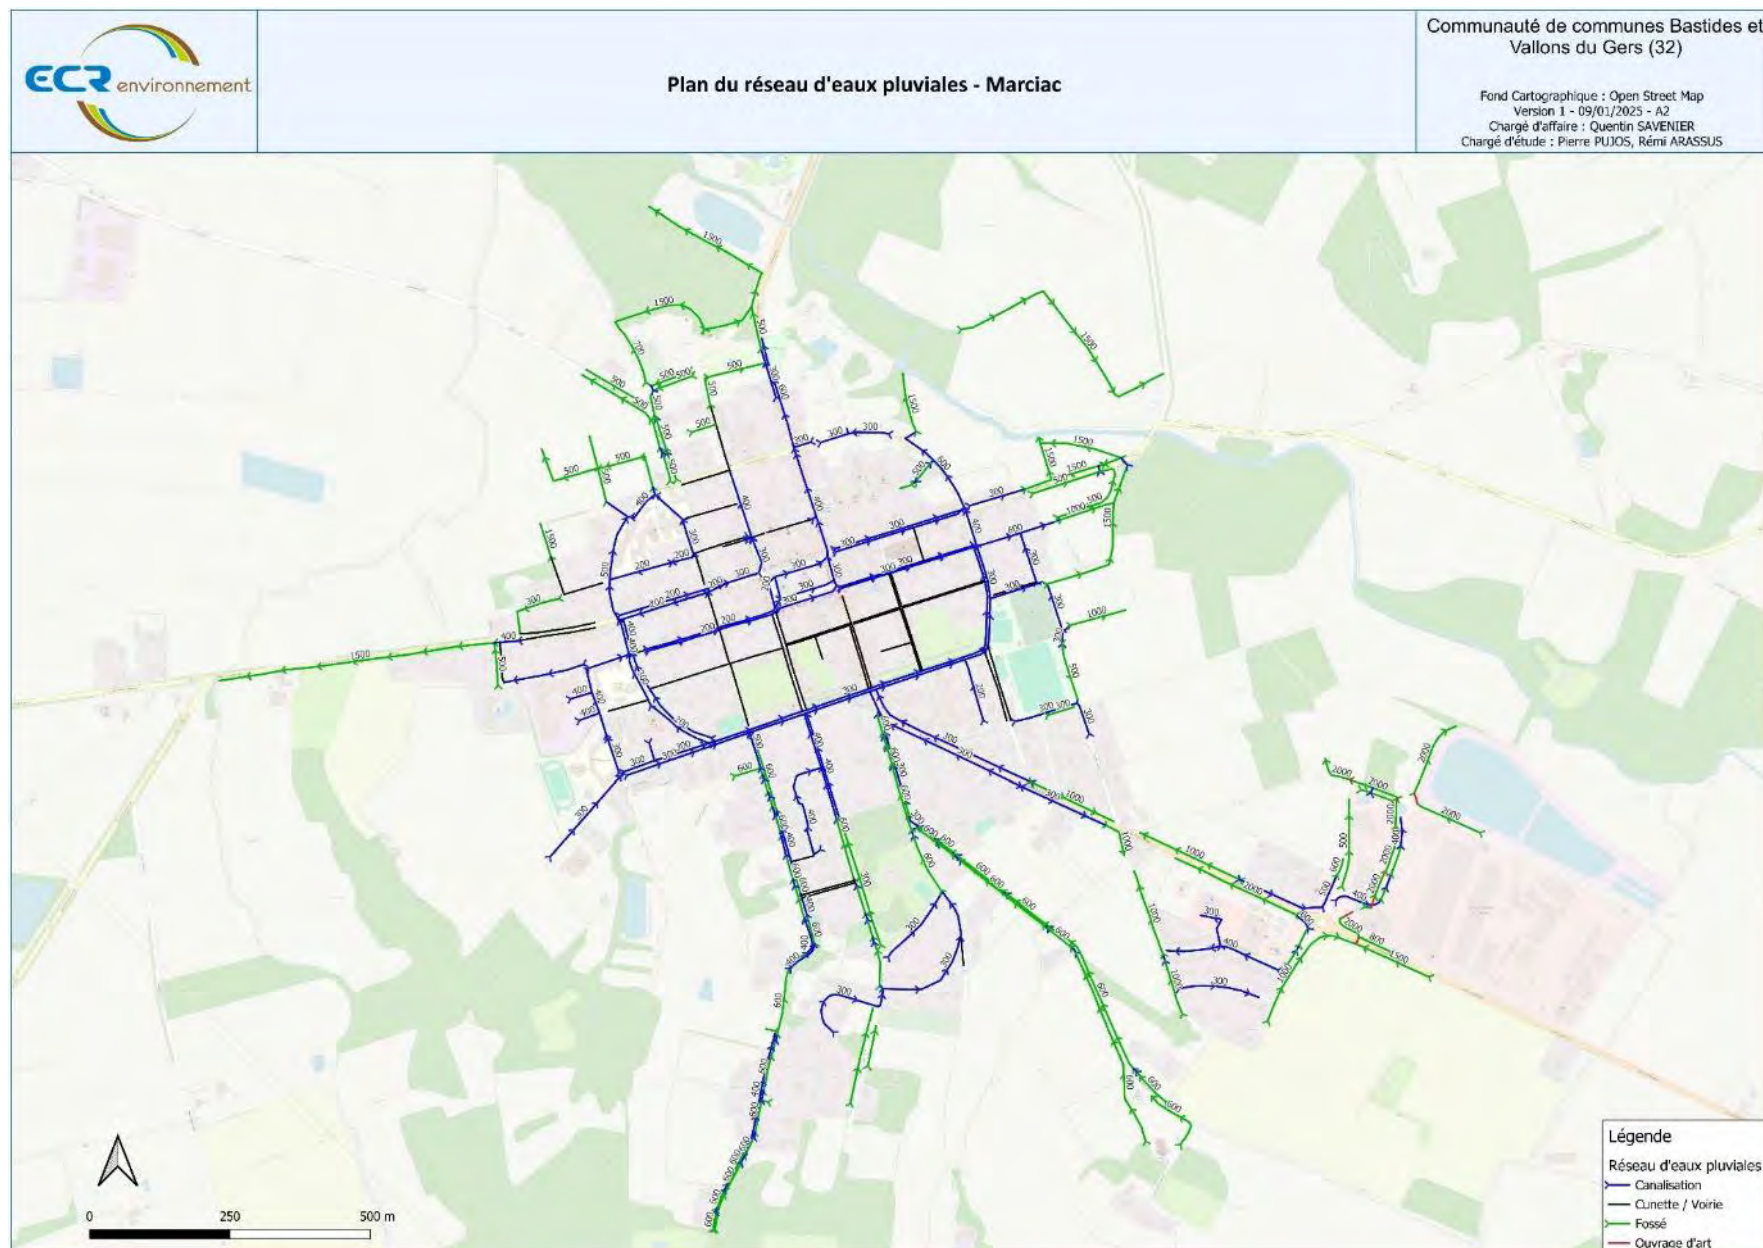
Plan du réseau d'eaux pluviales de Marciac, source ECR
